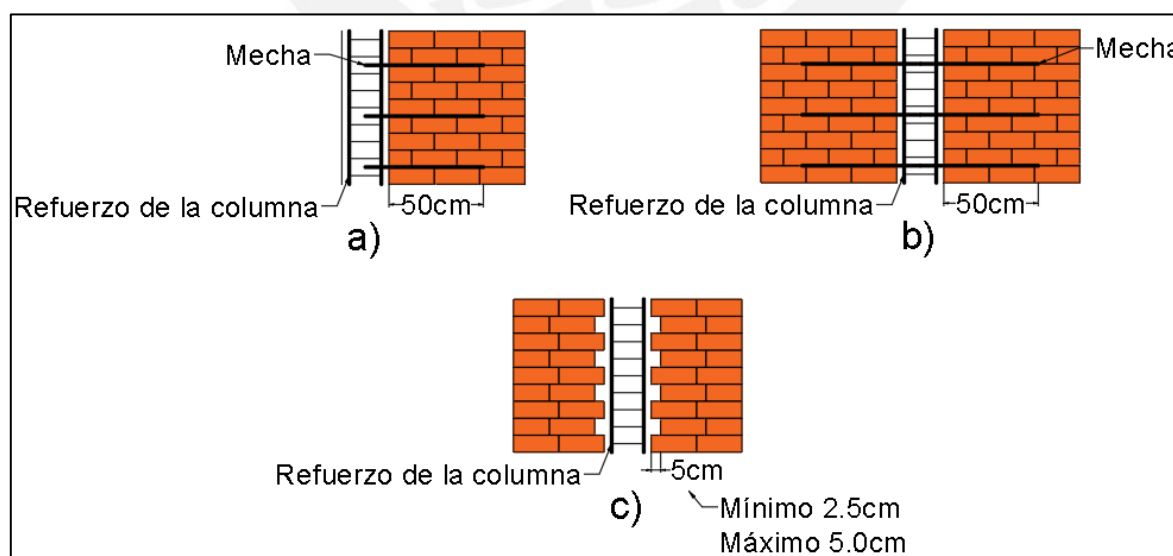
a) Muro a ras a un solo lado de la columna, b) Muro a ras en ambos lados de la columna y c) Muro dentado
